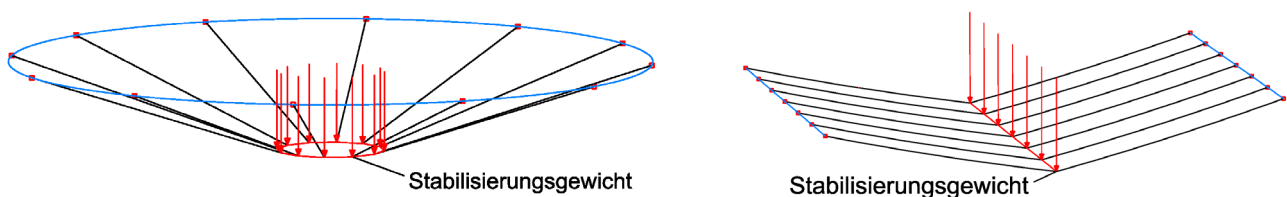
Ausführung von Dachflächen mit Stabilisierungsgewichten
